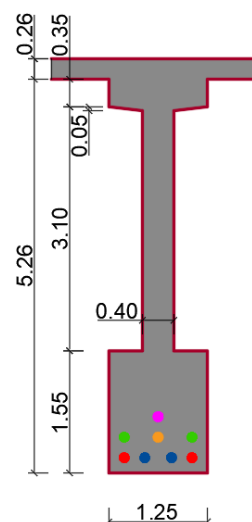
Secção transversal das vigas pré-esforçadas na zona de meio-vão
